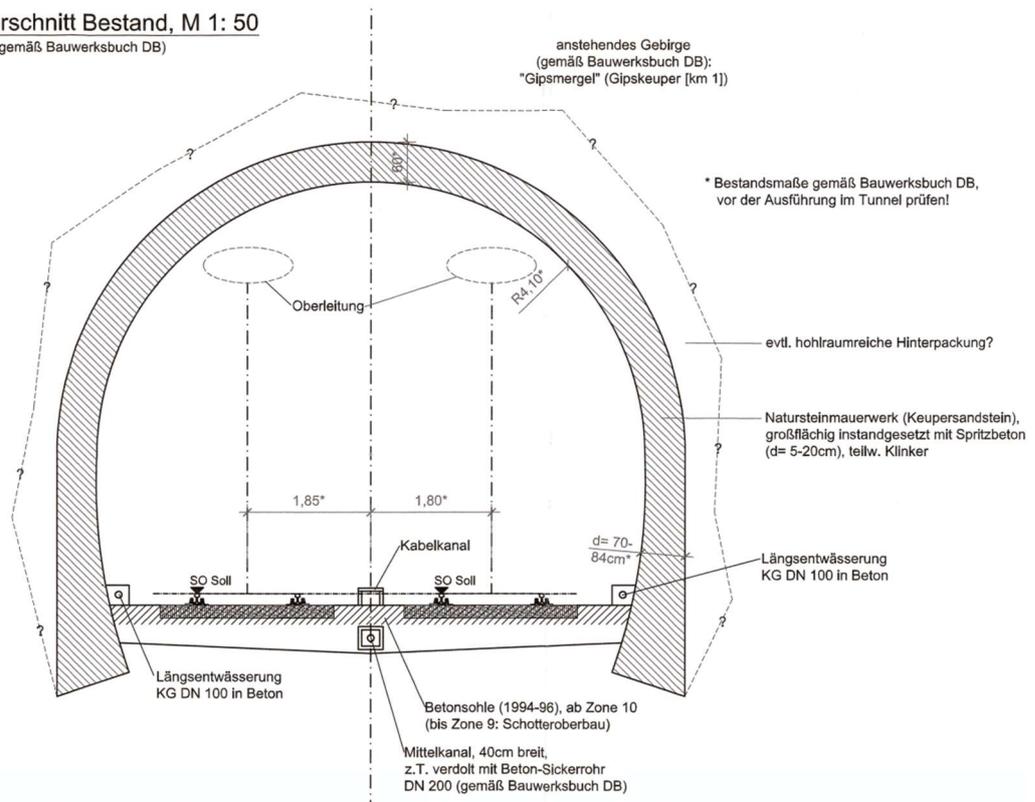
Regelquerschnitt Kriegsbergtunnel, aus "Instandsetzung Kriegsbergtunnel", Plan B-1, 2011
